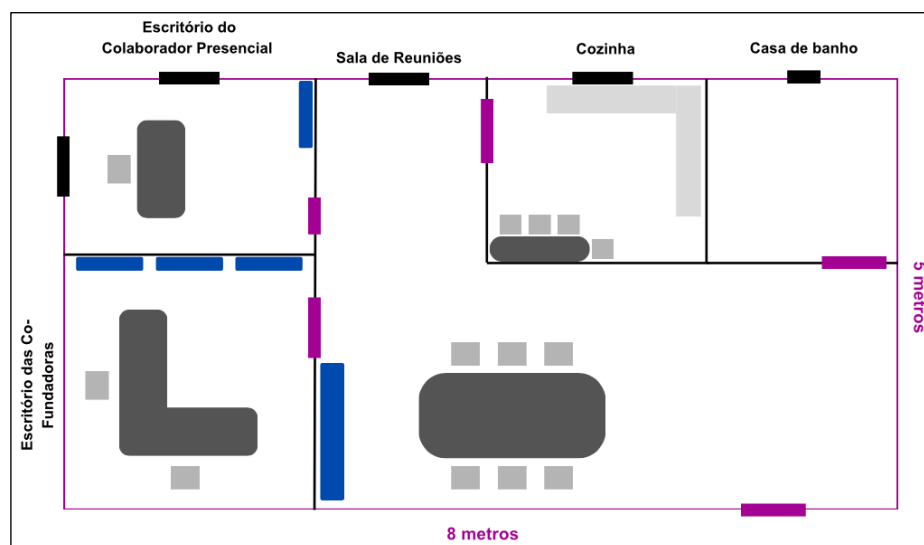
Planta do Espaço Onirix (vista aérea)
